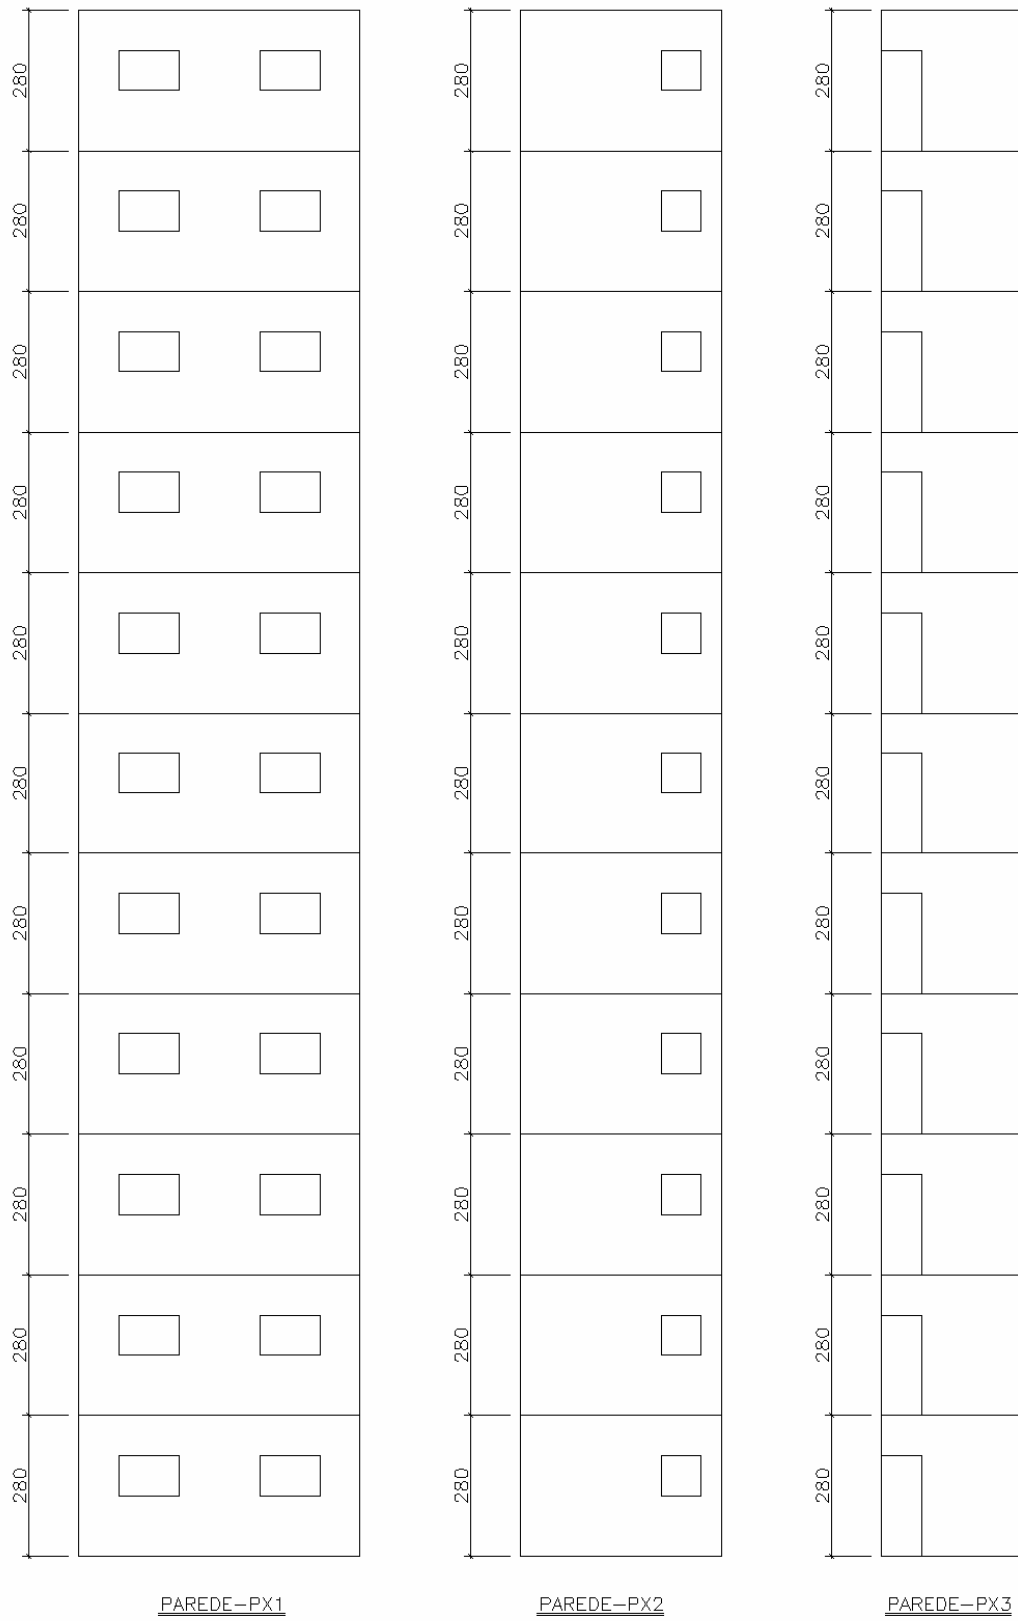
Vistas das paredes PX1 a PX3.
